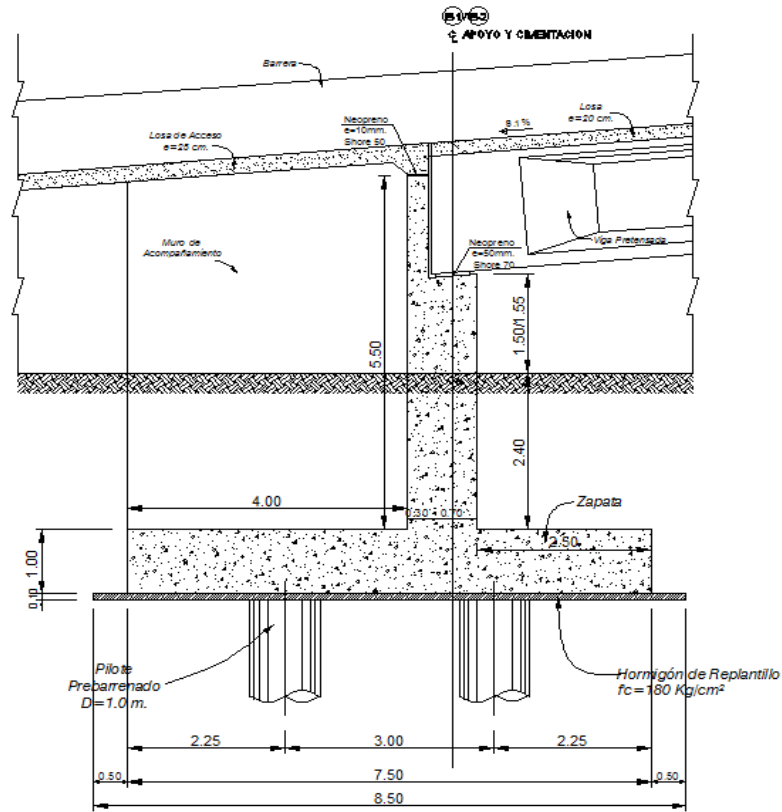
Distribución lateral de pilotes para el estribo E1.
